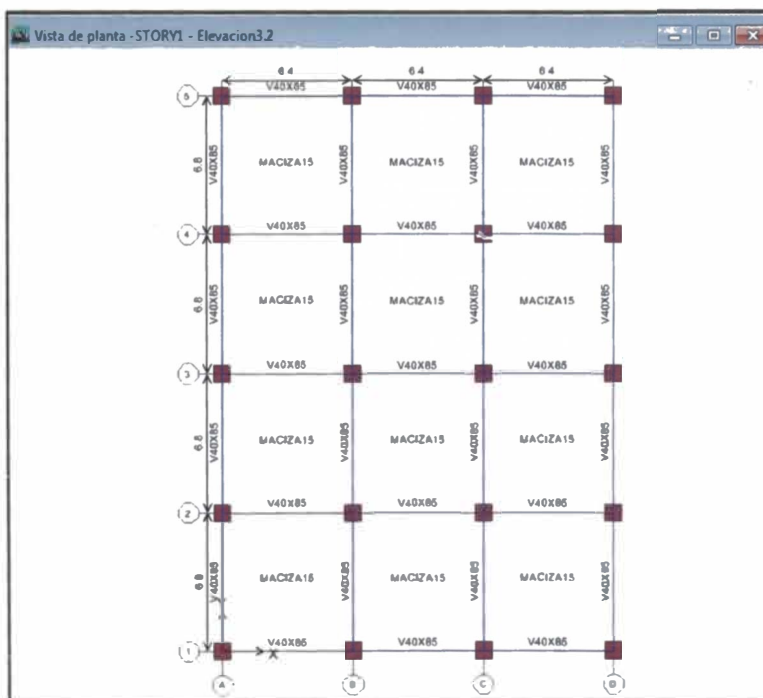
Vista en planta de la estructura de 5 pisos, Tipo 4
